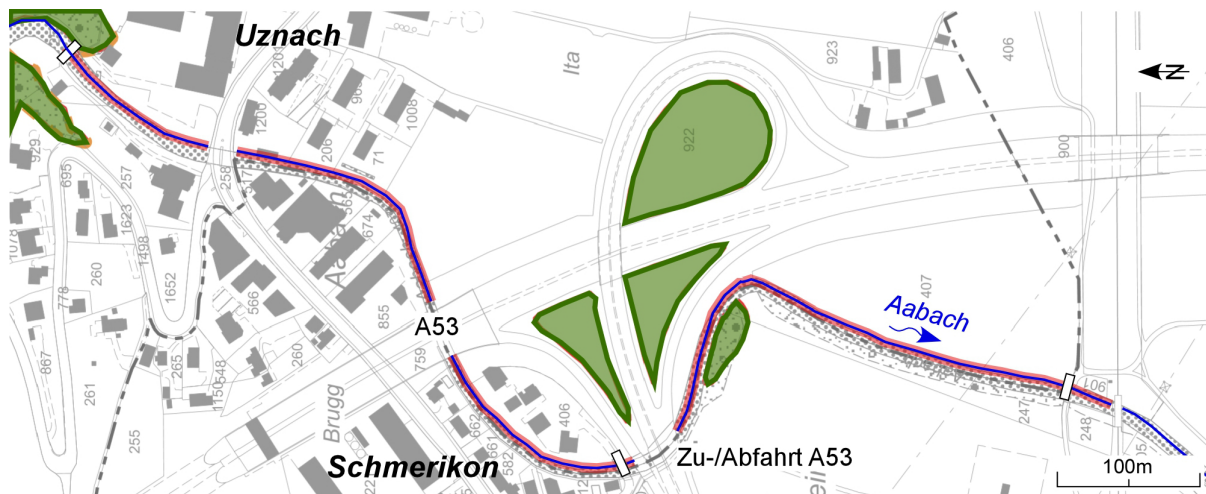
Situation mit Projektstrecke (rote Linie) und Basiswald [6] (grüne Flächen).
